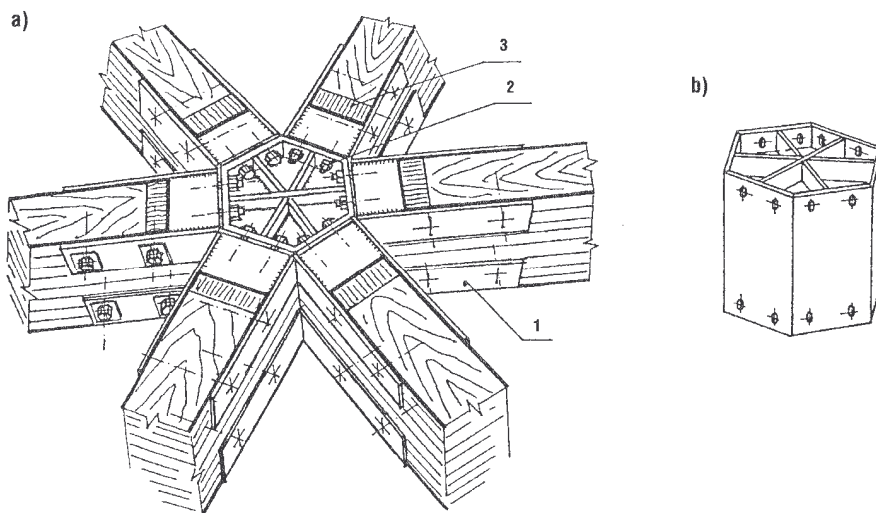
Konstruktivní řešení skladebných lamelových dílců:
